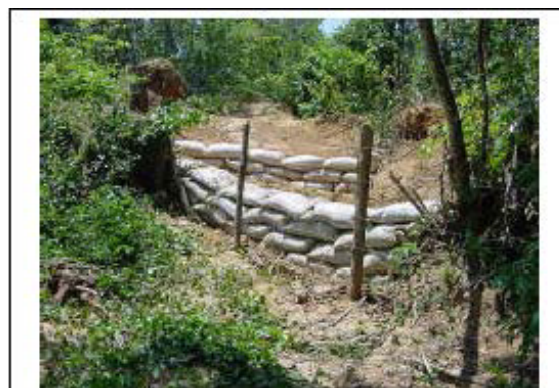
Recomposição de área degradada com muro de contenção.
